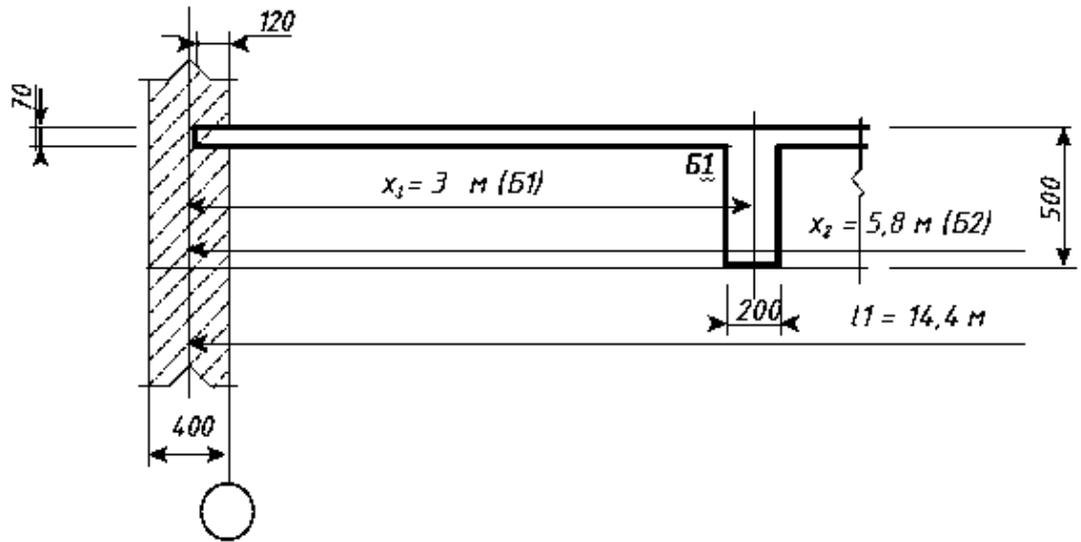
Общий вид монолитного кессонного перекрытия в разрезе.
